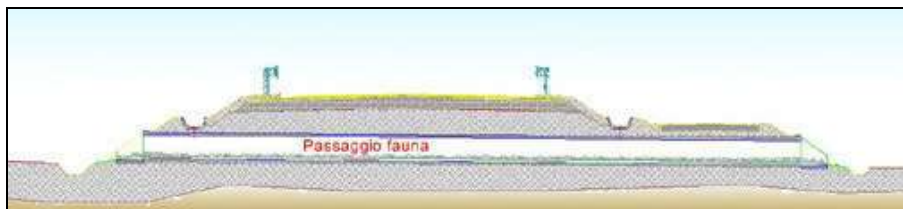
Sezione tipo per un passaggio sotto il manto stradale
